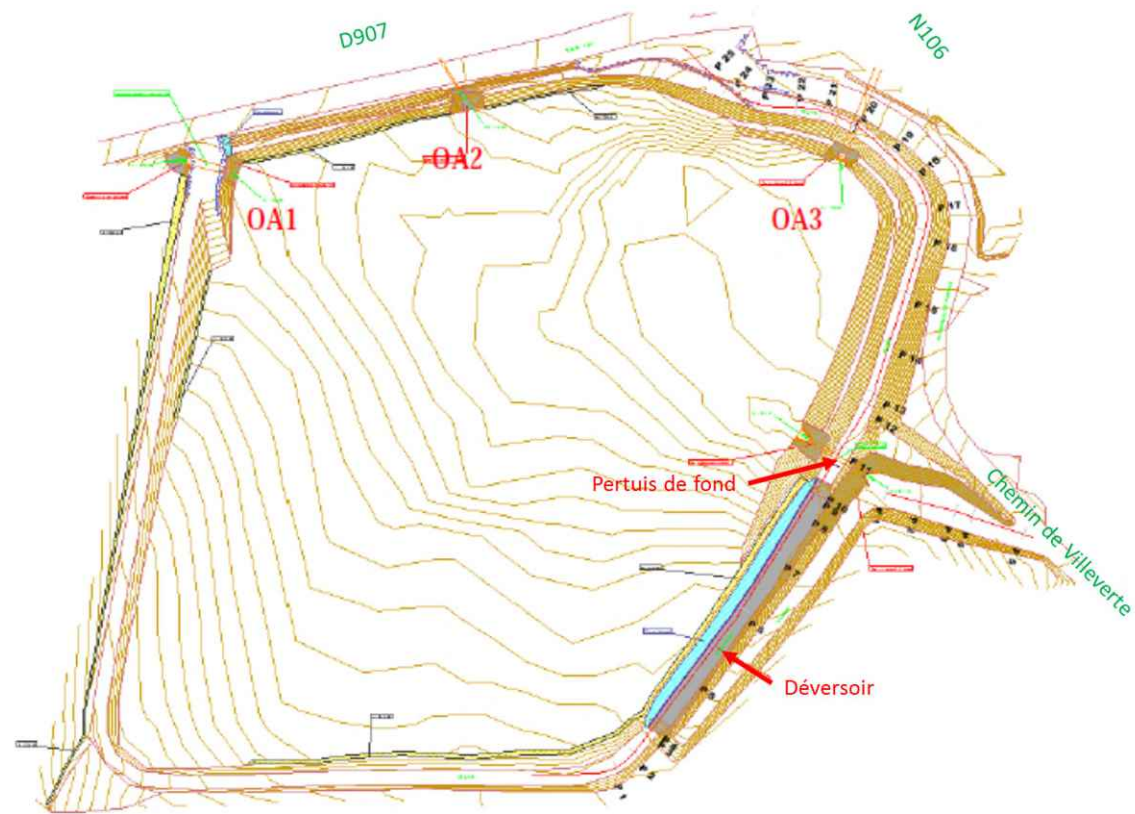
Plan de recollement du bassin d'Anduze (source : Nîmes Métropole)
